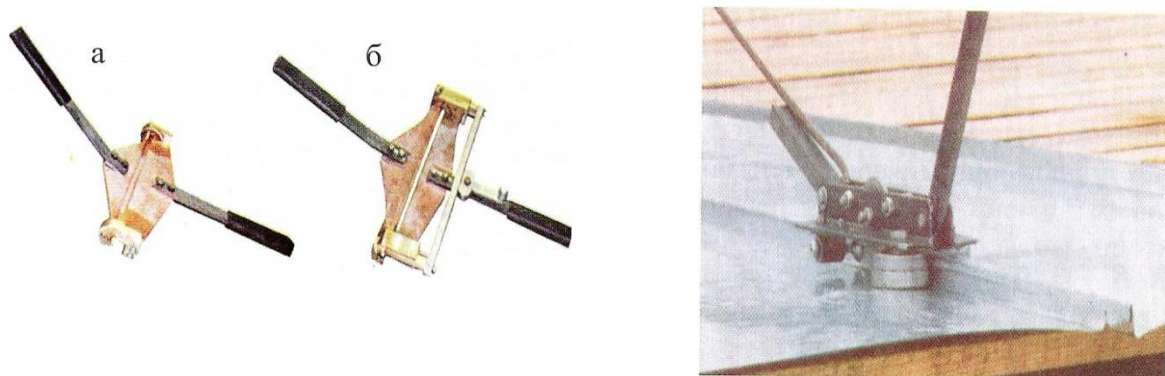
Ручний інструмент фальца: а - для первинної гнучкі готового кутового фальца; б - для завершального формування подвійного стоячого фальца
